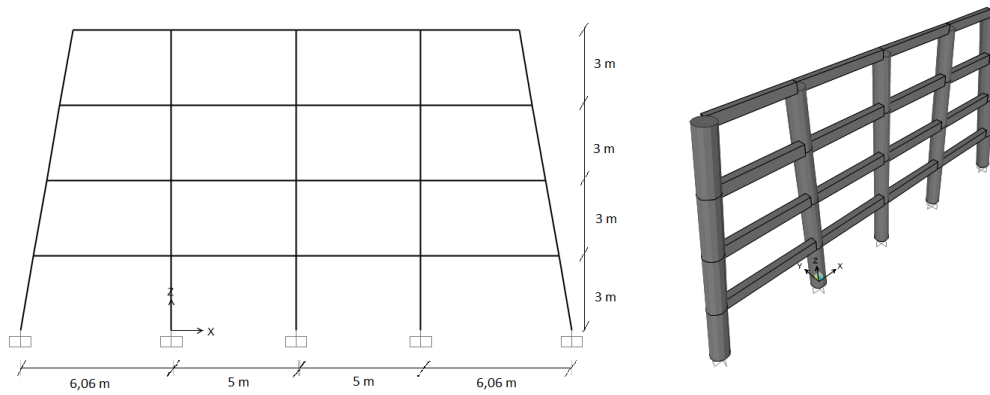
Pórtico Modelo A – 10g, inclinación de columnas 10° respecto al eje vertical.
